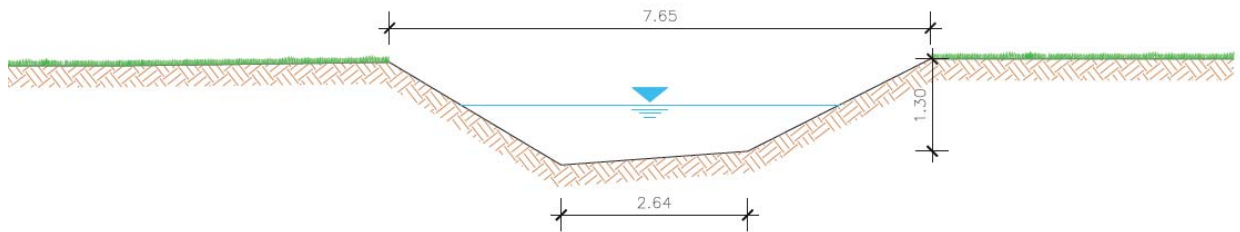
Sezione del canale Staggi 2° ramo, lato ovest dell'attraversamento stradale
